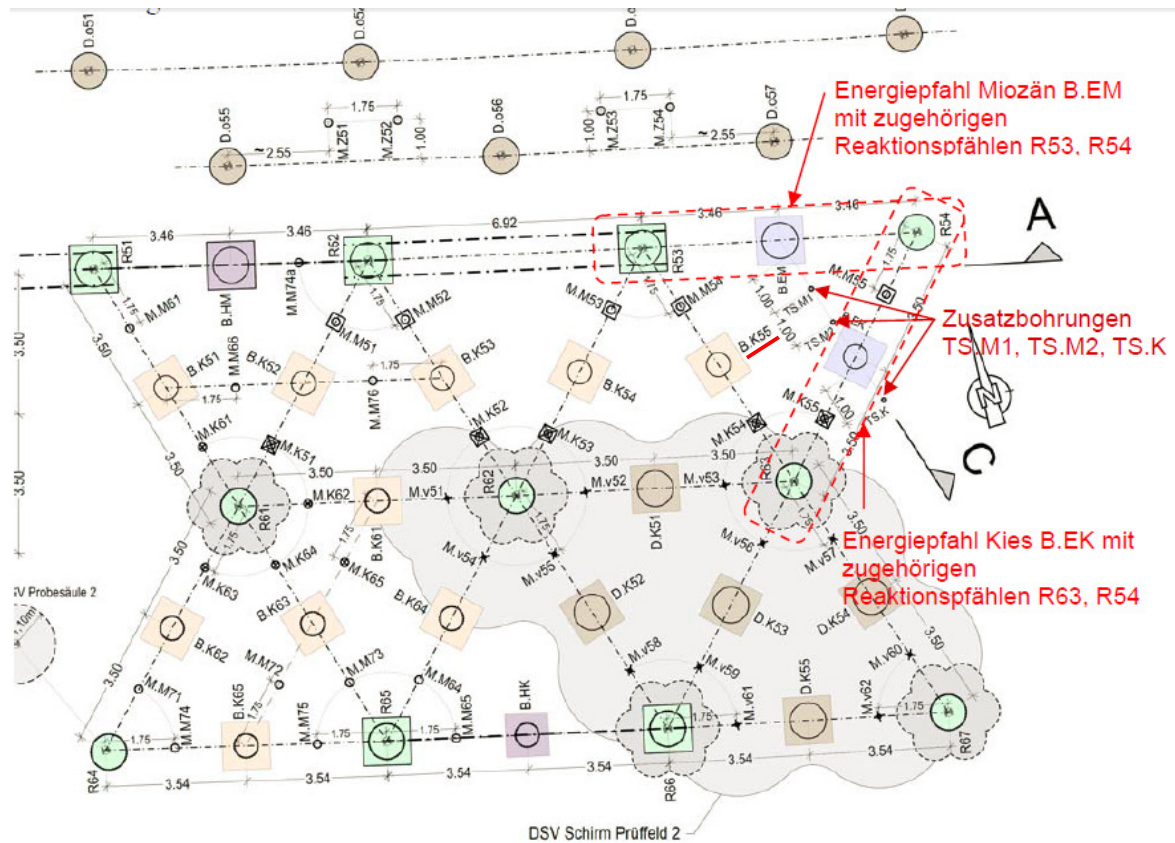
Grundriss des Prüffeld 2 mit Lage der Energiepfähle, Reaktionspfähle und Zusatzbohrungen, Plan-ausschnitt aus [46]
